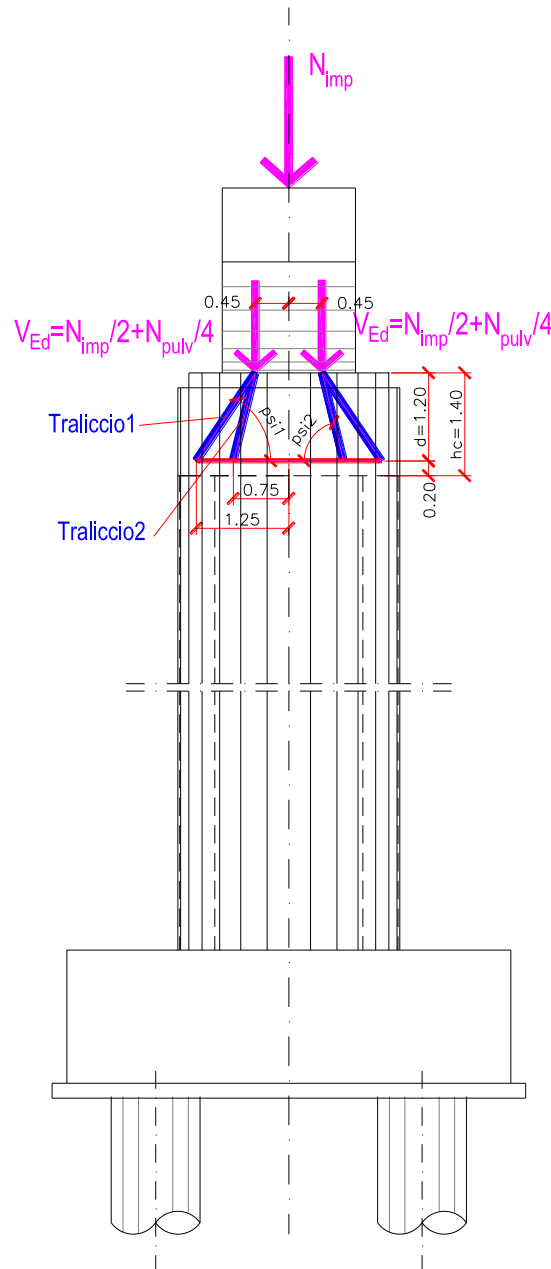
Schema statico per verifica tappo testa pila - Pila Tipo
